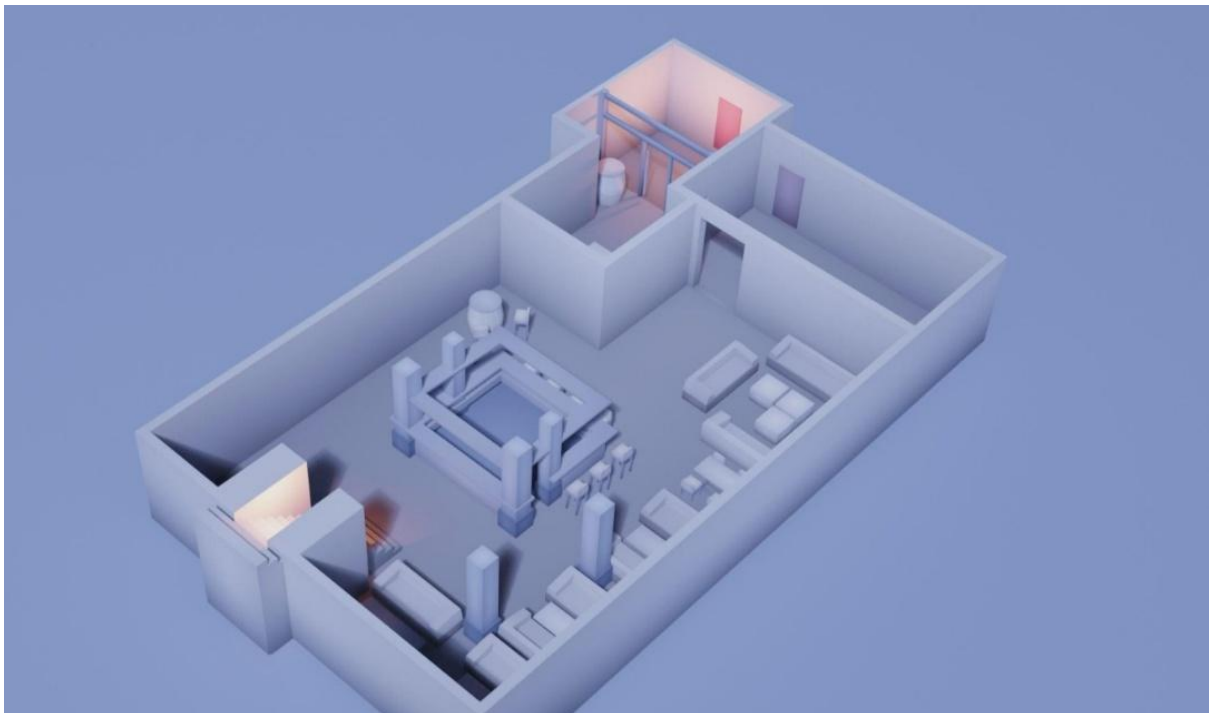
Pianta interrato, Radio Télévision Suisse, www.rts.ch, Le plan du bar "Le Constellation" à Crans-Montana
